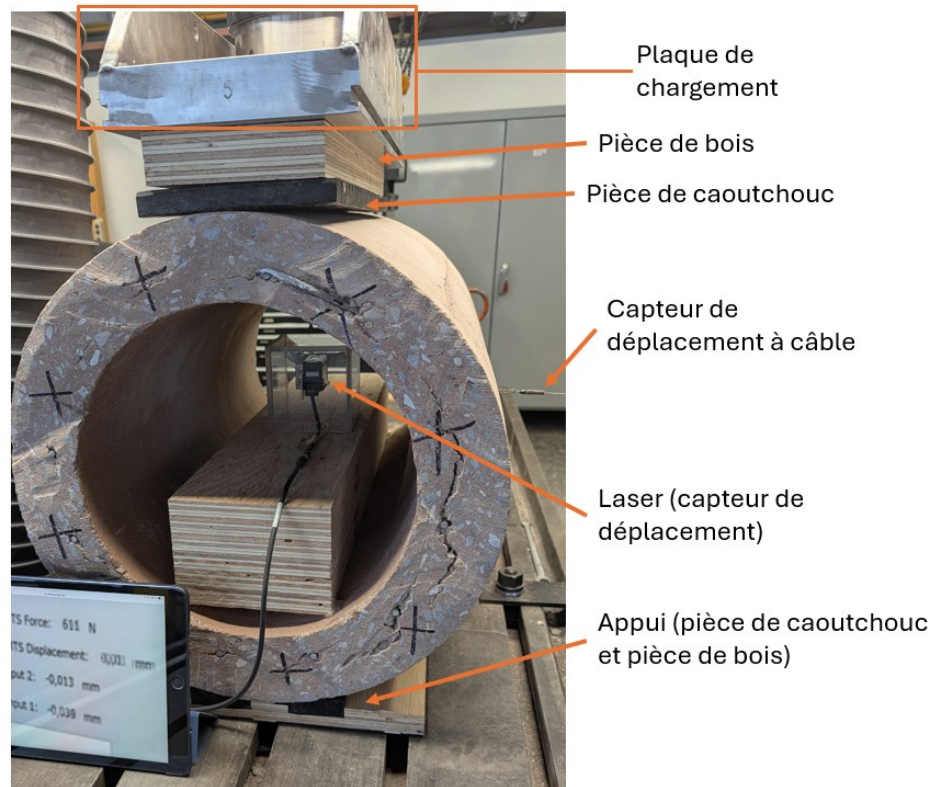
Montage expérimental pour les essais sur section de tuyaux en laboratoire
